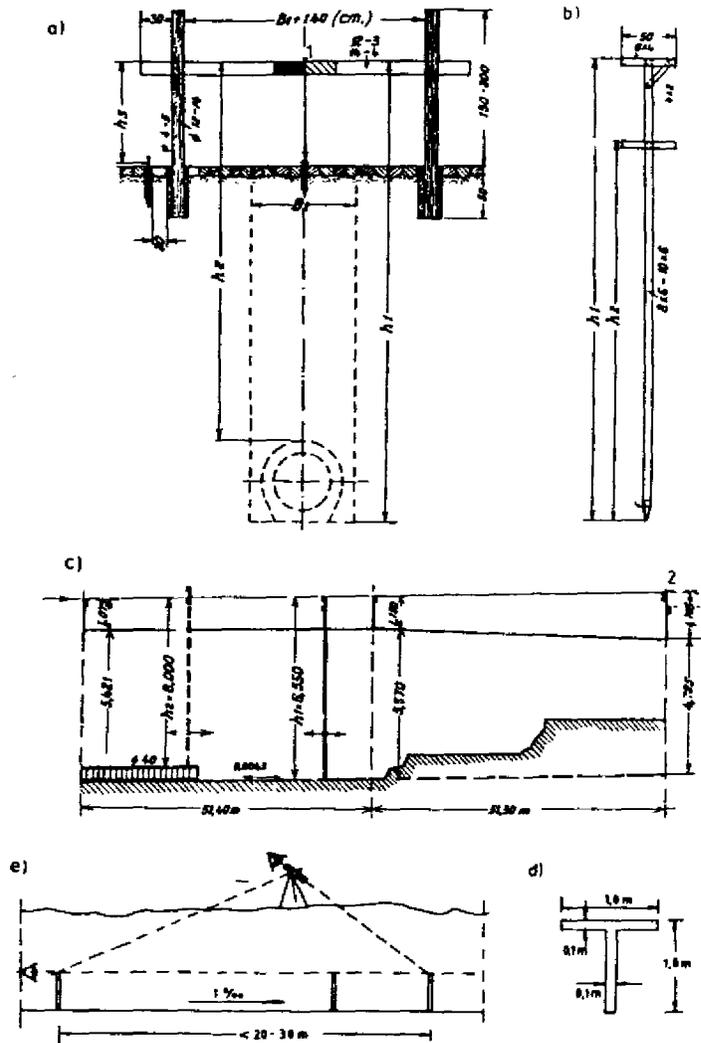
2: Tableros provisionales para la construcción de alcantarillas
